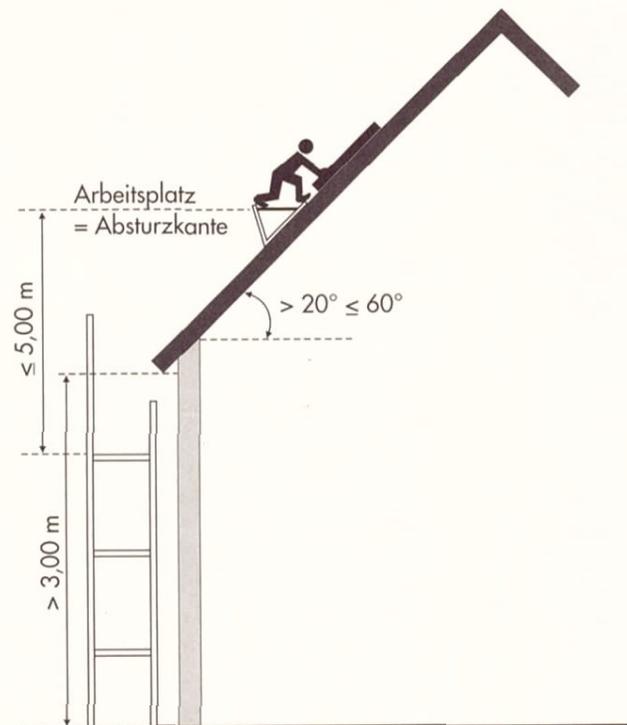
Dachfanggerüste für Arbeiten auf geneigten Dachflächen.
